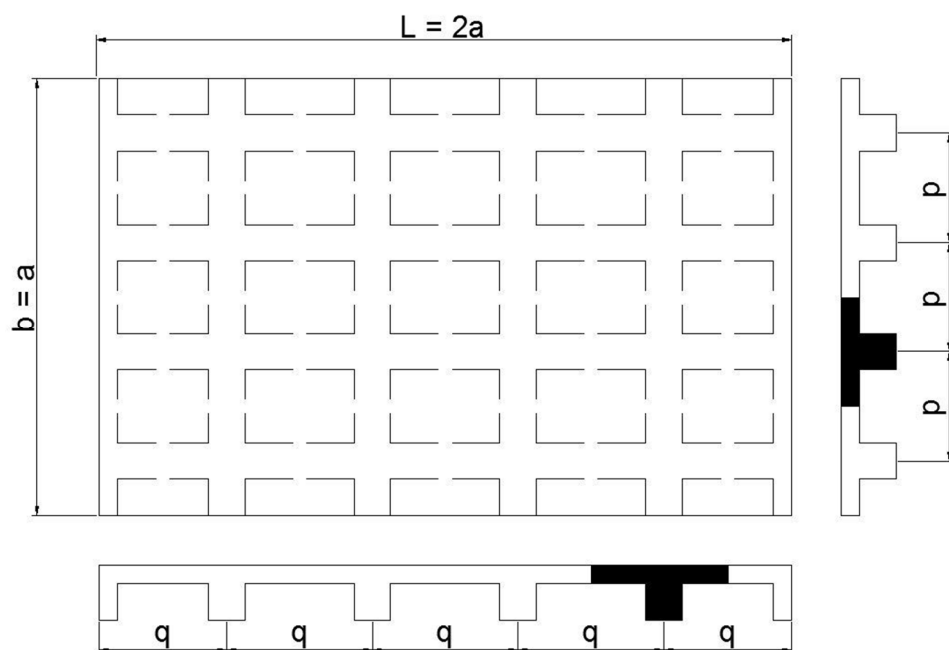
Vista inferior e cortes de um tabuleiro de ponte
